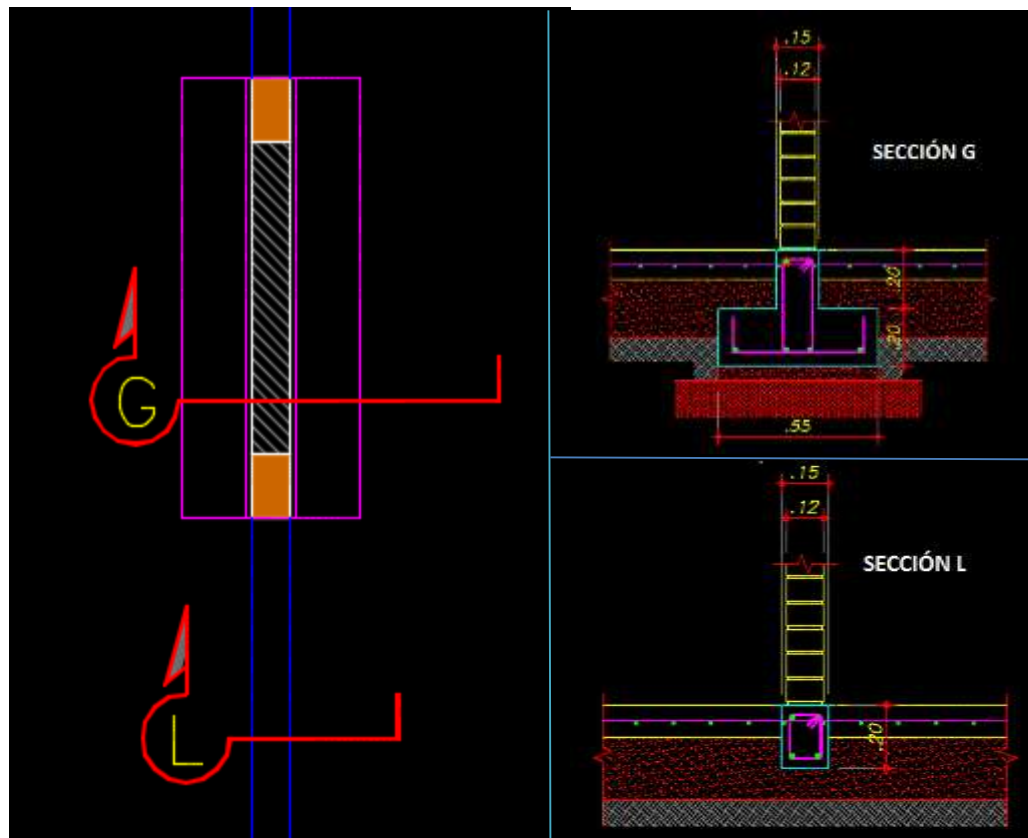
Sección L (viga) – Sección G (Zapata)
